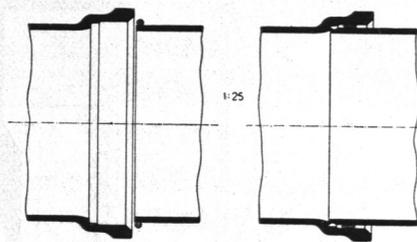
Gußeiserne Heberleitung mit eingewalzten Gummidichtungsringen.
